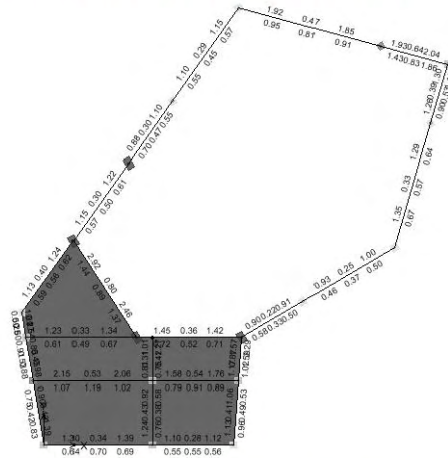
Refuerzos longitudinales en vigas – cubierta
